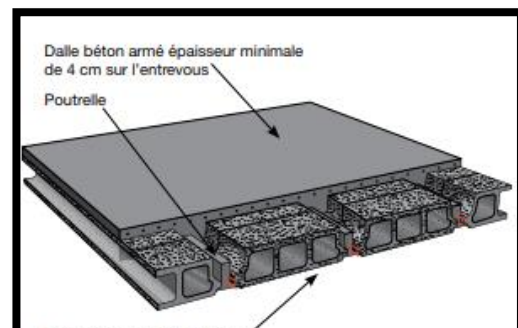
PLANCHER EN POUTRELLES HOURDIS
